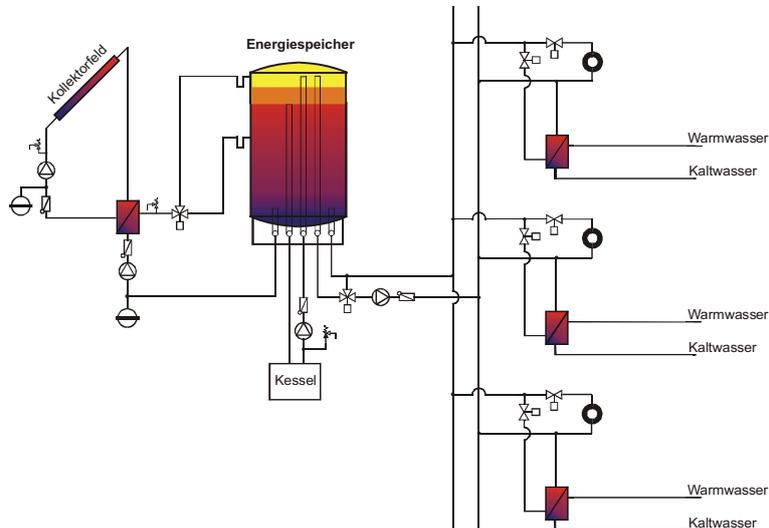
Ansicht der beschriebenen, vorteilhaften Anlagenhydraulik für Neubauten im Segment Geschloßwohnbau (Quelle: AEE INTEC)
